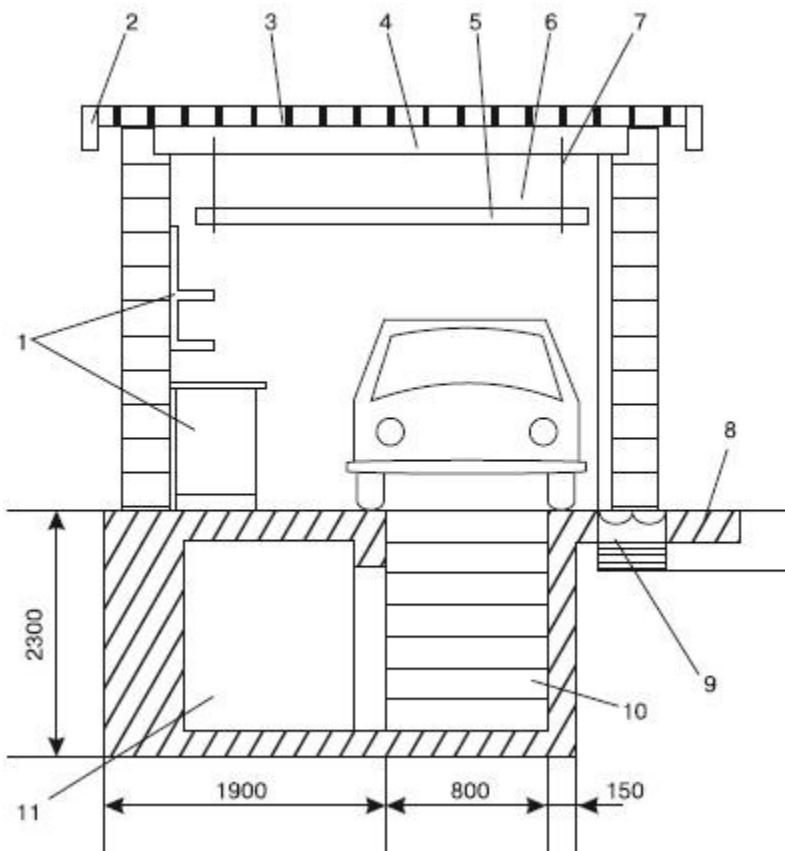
Комфортный и простой гараж со смотровой ямой и подвалом: 1 – верстак с тисками и стеллажи; 2 – облицовочная доска; 3 – рувероид; 4 – балка перекрытия; 5 – балка навесного потолка; 6 – щит антресоли; 7 – петля навески антресоли; 8 – отмостка; 9 – фундамент; 10 – смотровая яма; 11 – подвал
